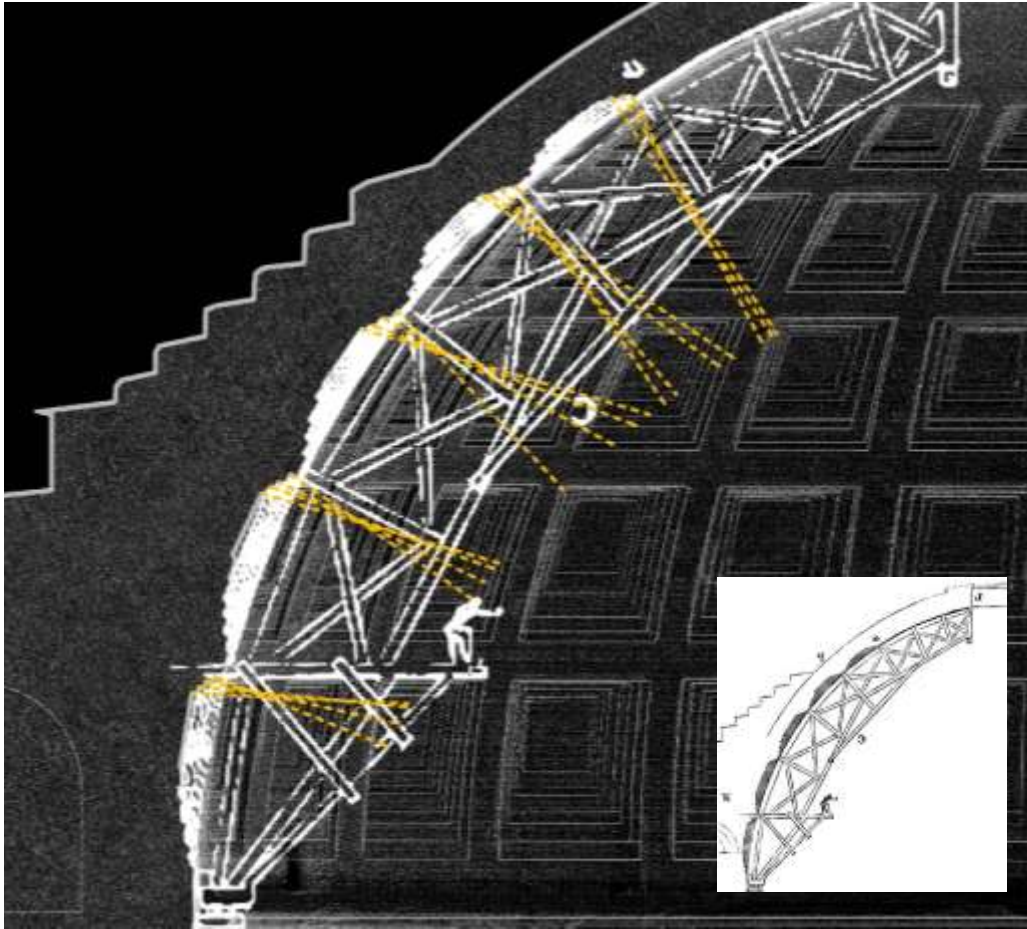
Sovrapposizione tra la Sezione trasversale e il ponteggio ipotizzato da Viollet-le-Duc - I lati superiori dei cassettoni convergono in un'area facilmente accessibile per la stesura dell'intonaco.
